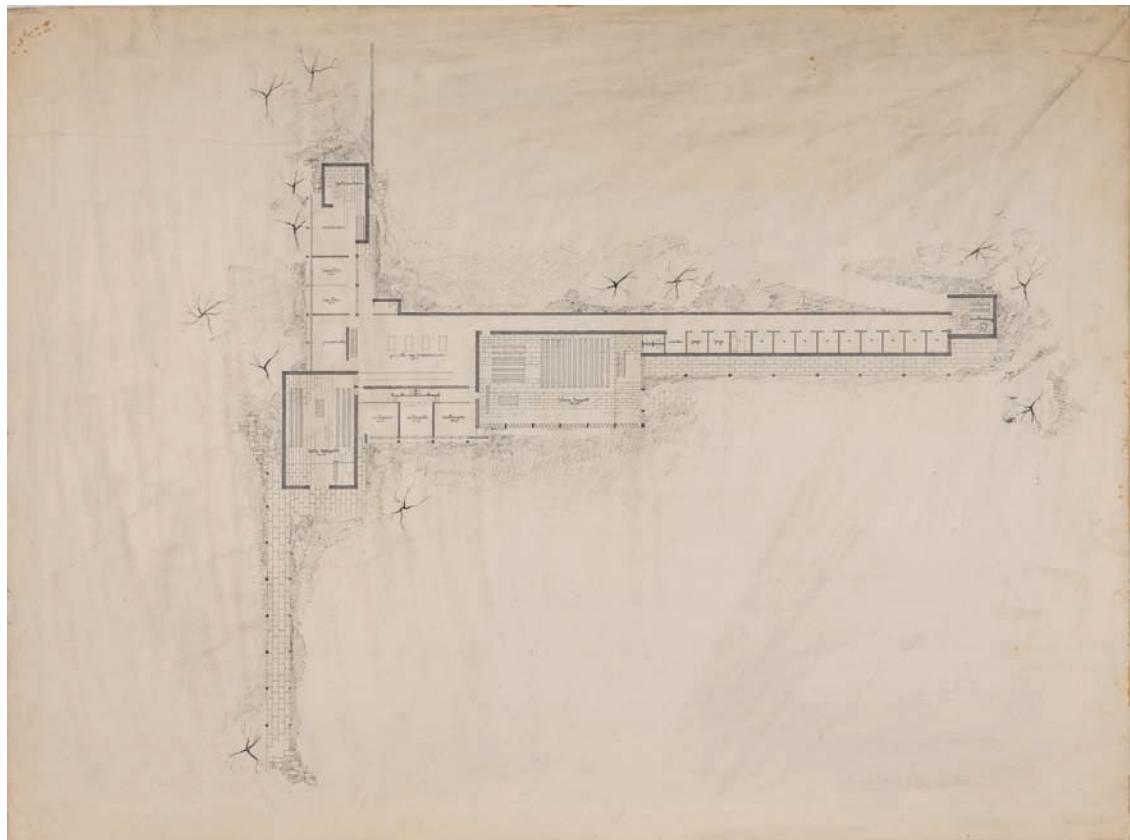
Disegno di archivio. S. Fehn, Progetto di tesi per un crematorio, pianta del piano terra, 1949.
